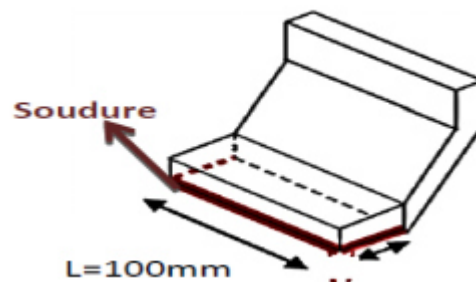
Fixation de lisse avec poteau par soudure.
